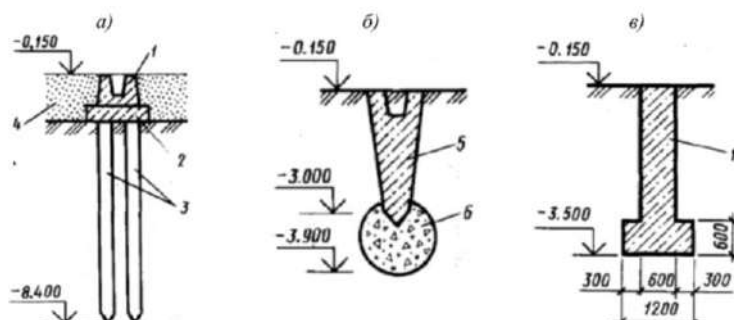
Устройство фундаментов в вечномерзлых грунтах с предварительным оттаиванием мерзлого грунта (II принцип): а - из буронабивных свай, б - фундамент в вытрамбованном котловане ФВК, в - ленточный
